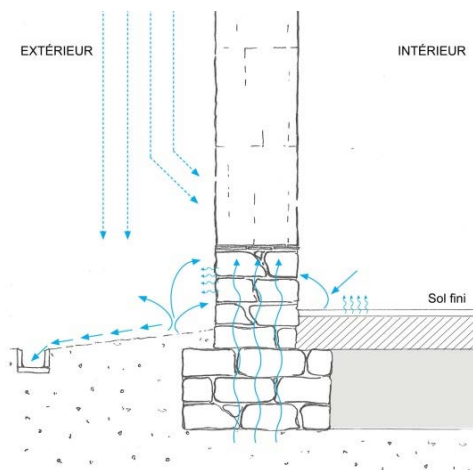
Fondation soubassement\* pierres, sol enherbé et canal de pierres
